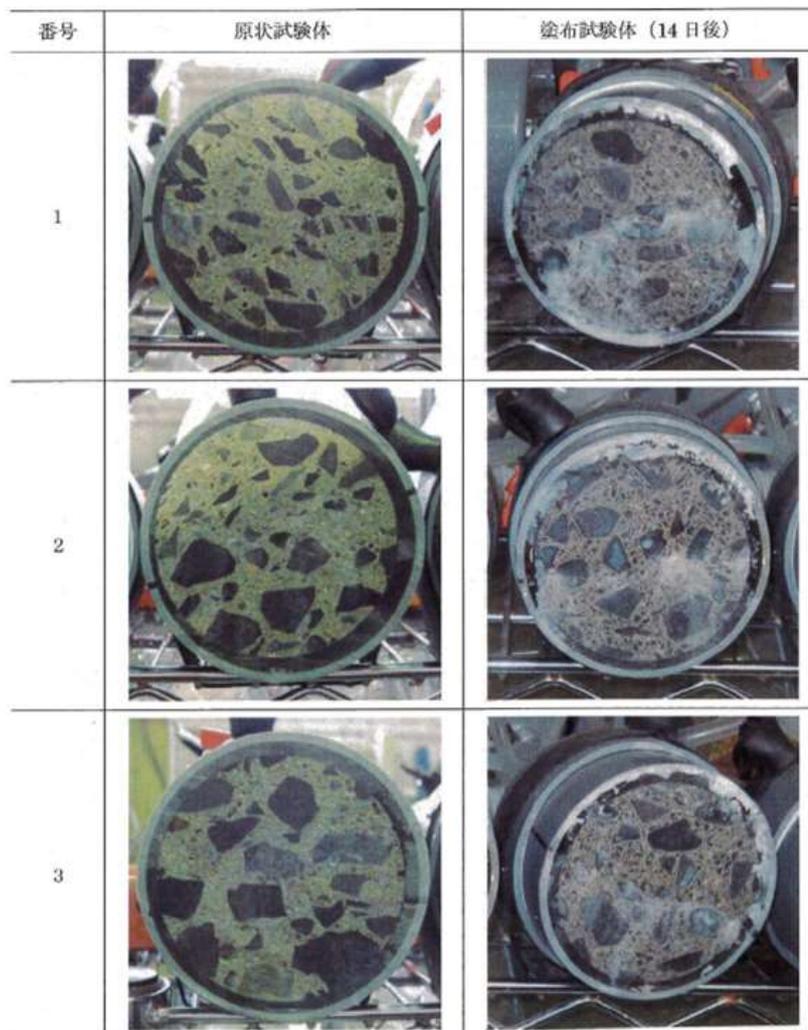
ひび割れ透水性試験完了状況 (コンクリート)
